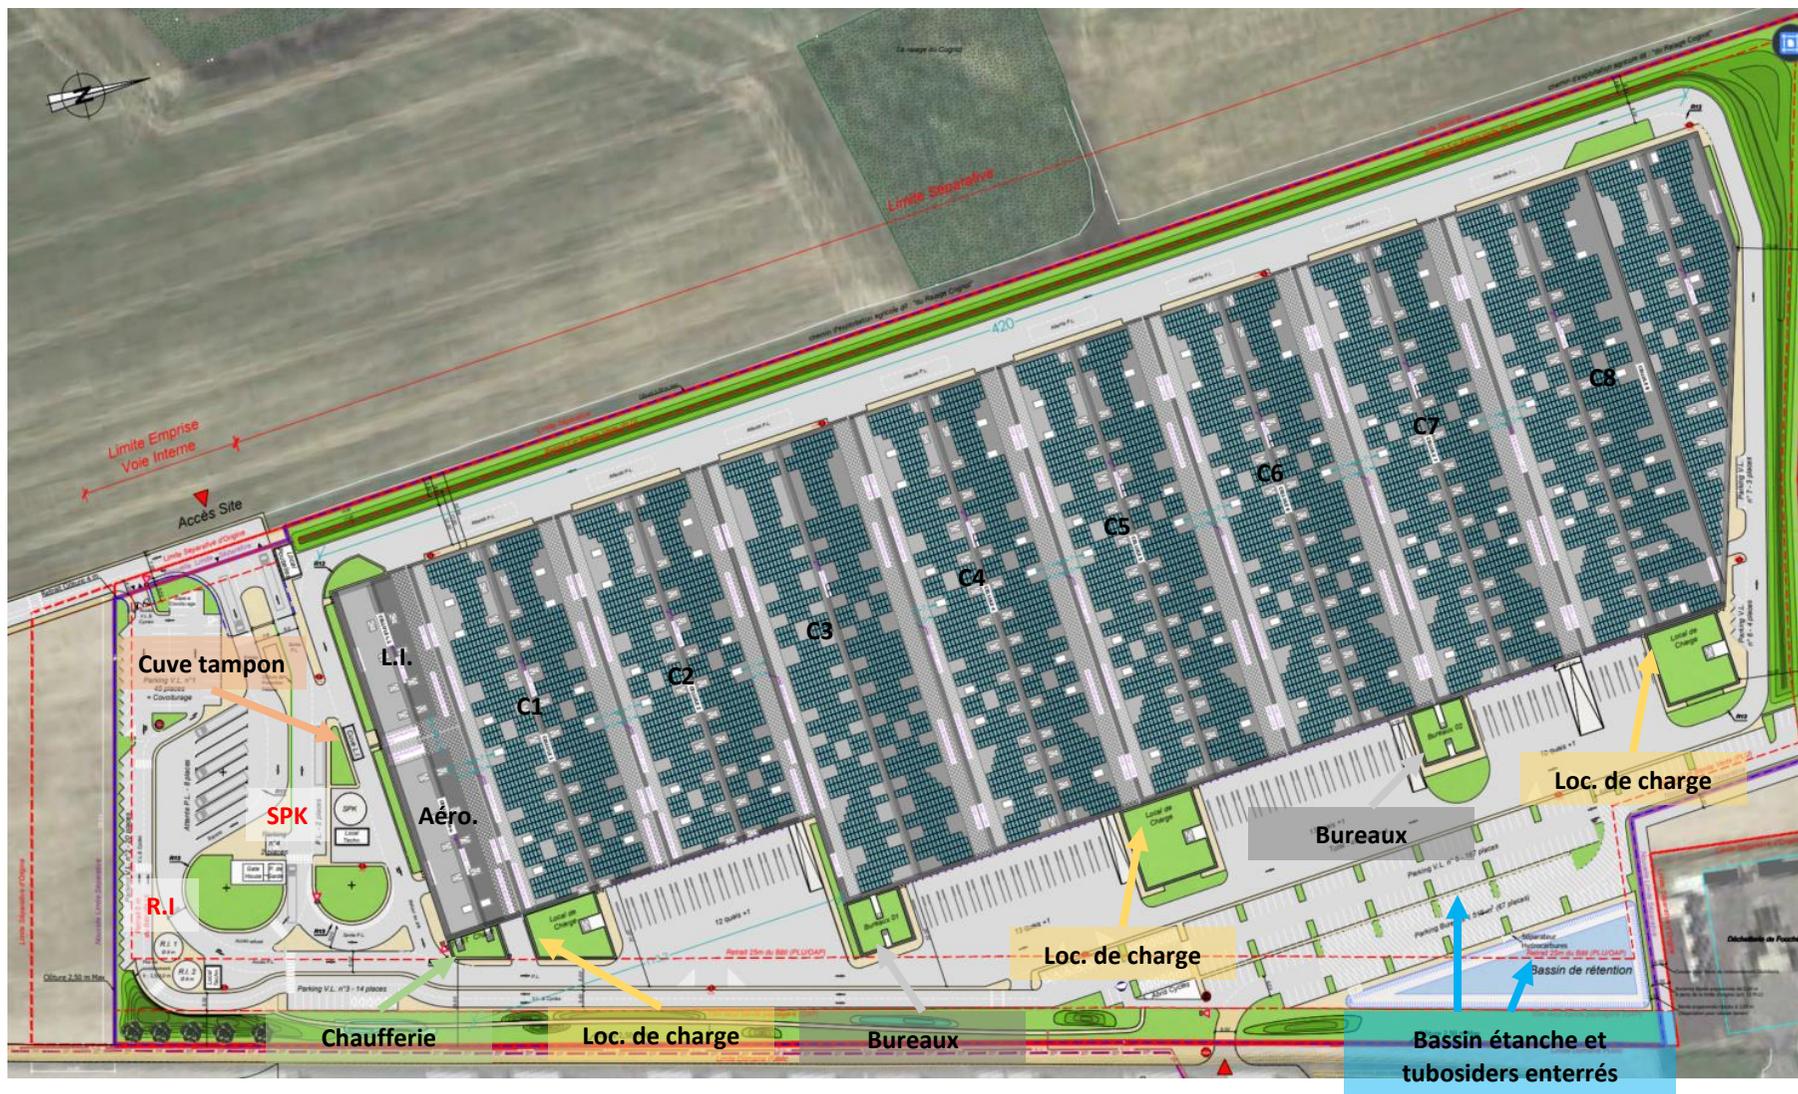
Plan de masse du projet (Extrait de la pièce 1201 - PC 02A ind.5 - Plan Masse)
